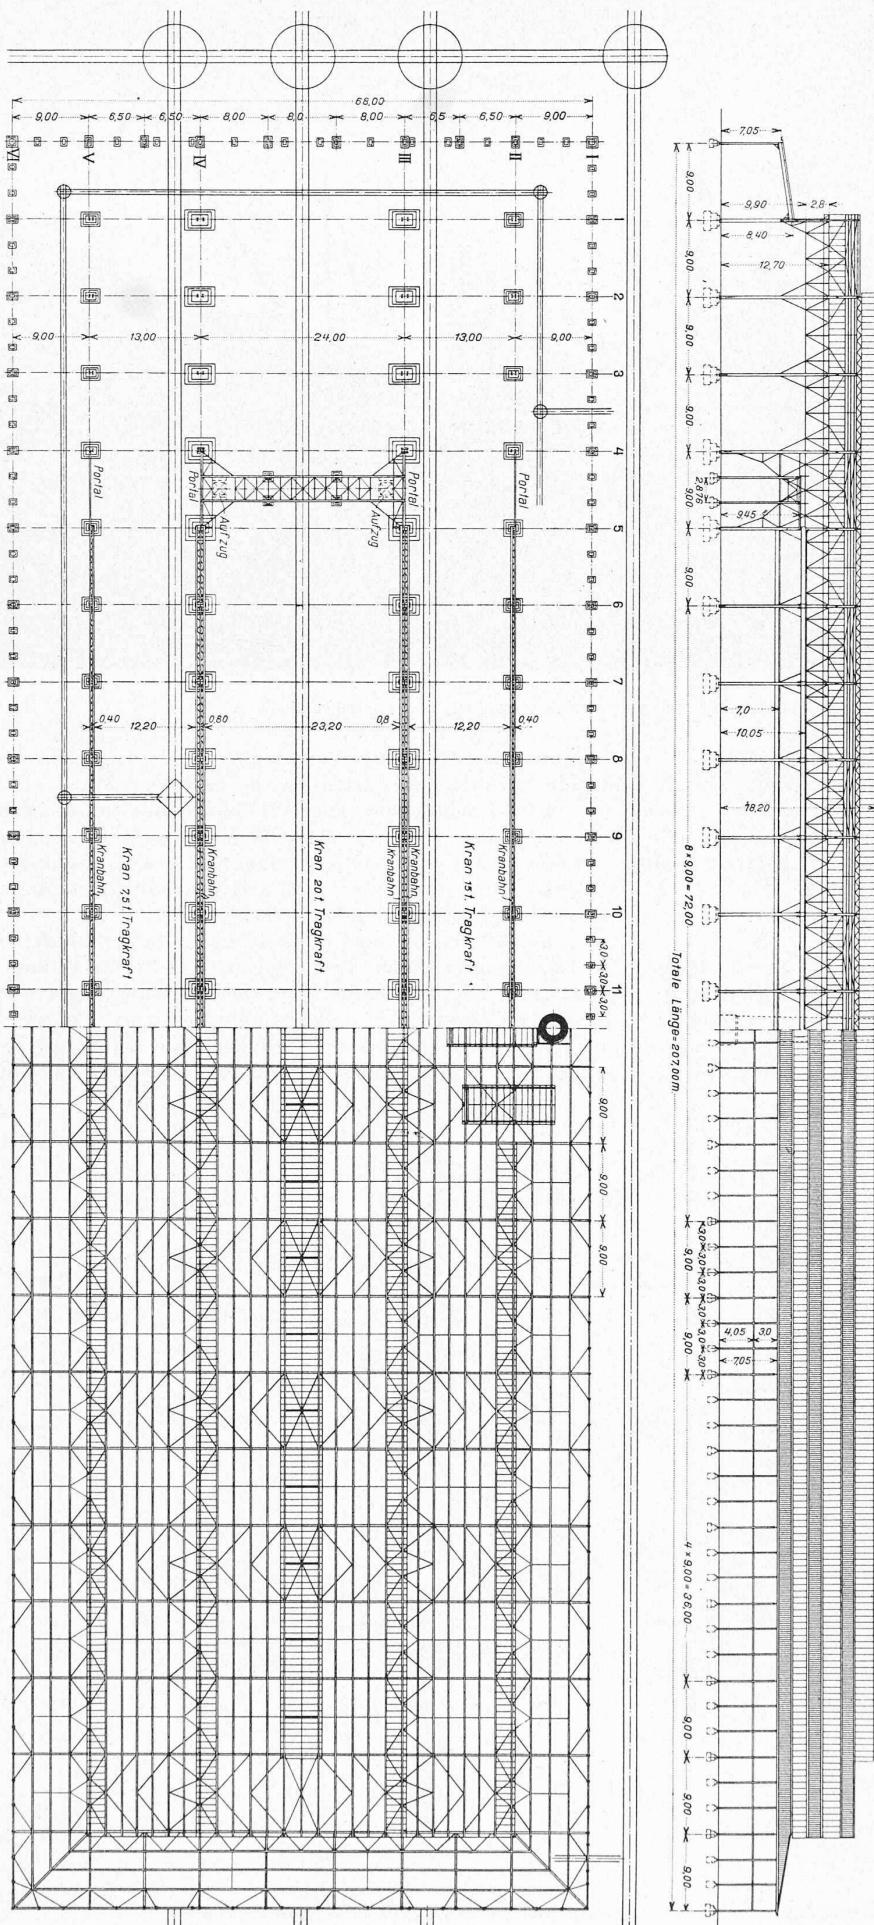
Grundriss und Draufsicht, Längsschnitt und Ansicht der Maschinenhalle der Schweiz. Landesausstellung in Bern. — Massstab 1:800.
